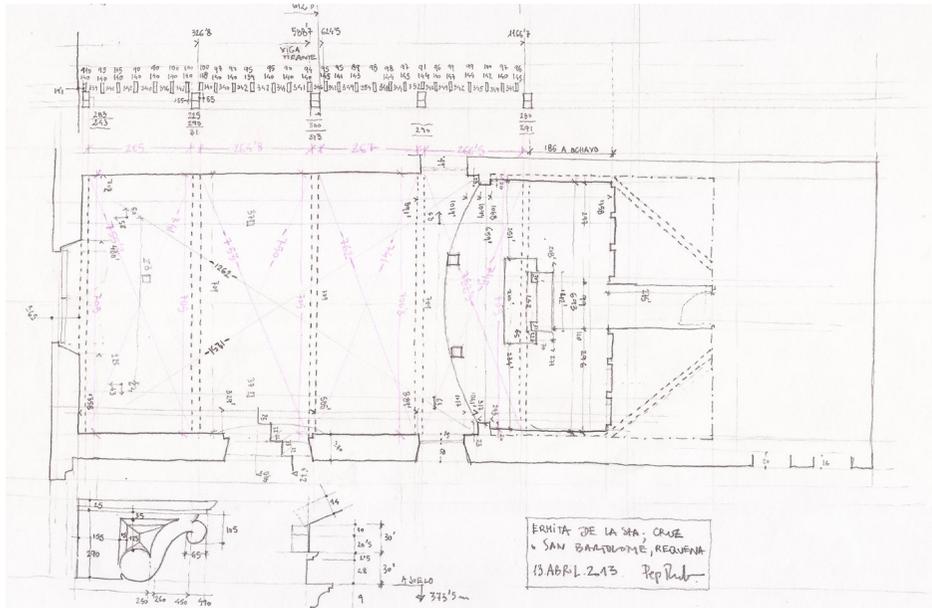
Croquis de la planta de la Ermita de San Bartolomé. En colaboración con José Pardo
